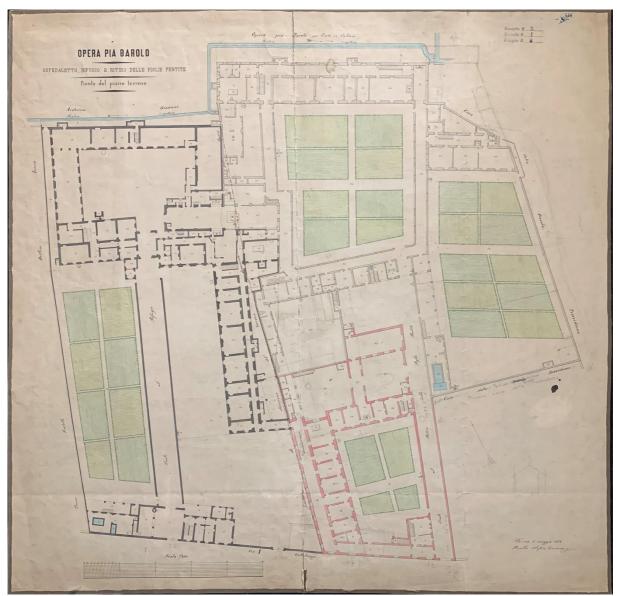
Alessio Ruella, *Opera Pia Barolo Ospedaletto, Rifugio e Ritiro delle Figlie Pentite pianta del piano terreno*, 1874 (AAOPB, sezione VI, Planimetrie, stampe, disegni e manifesti, VI.3.1-4)
